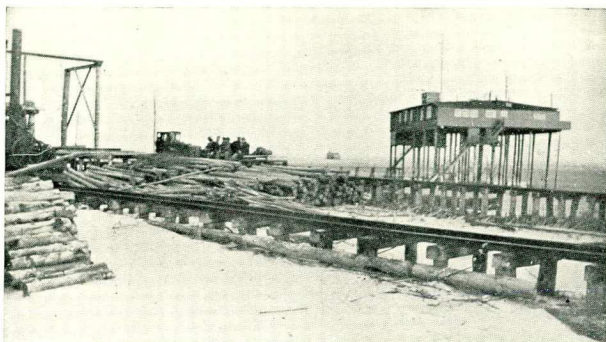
4-tons kraan voor het stellen der betonblokken, in bedrijf bij hoofd B.
